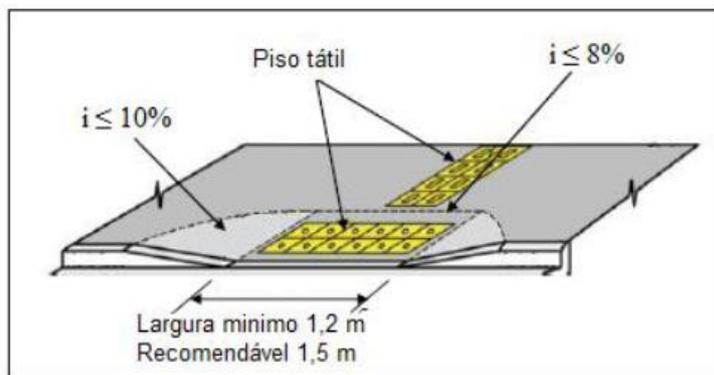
Dimensões recomendadas para projeto de rampa de acesso a travessia.
